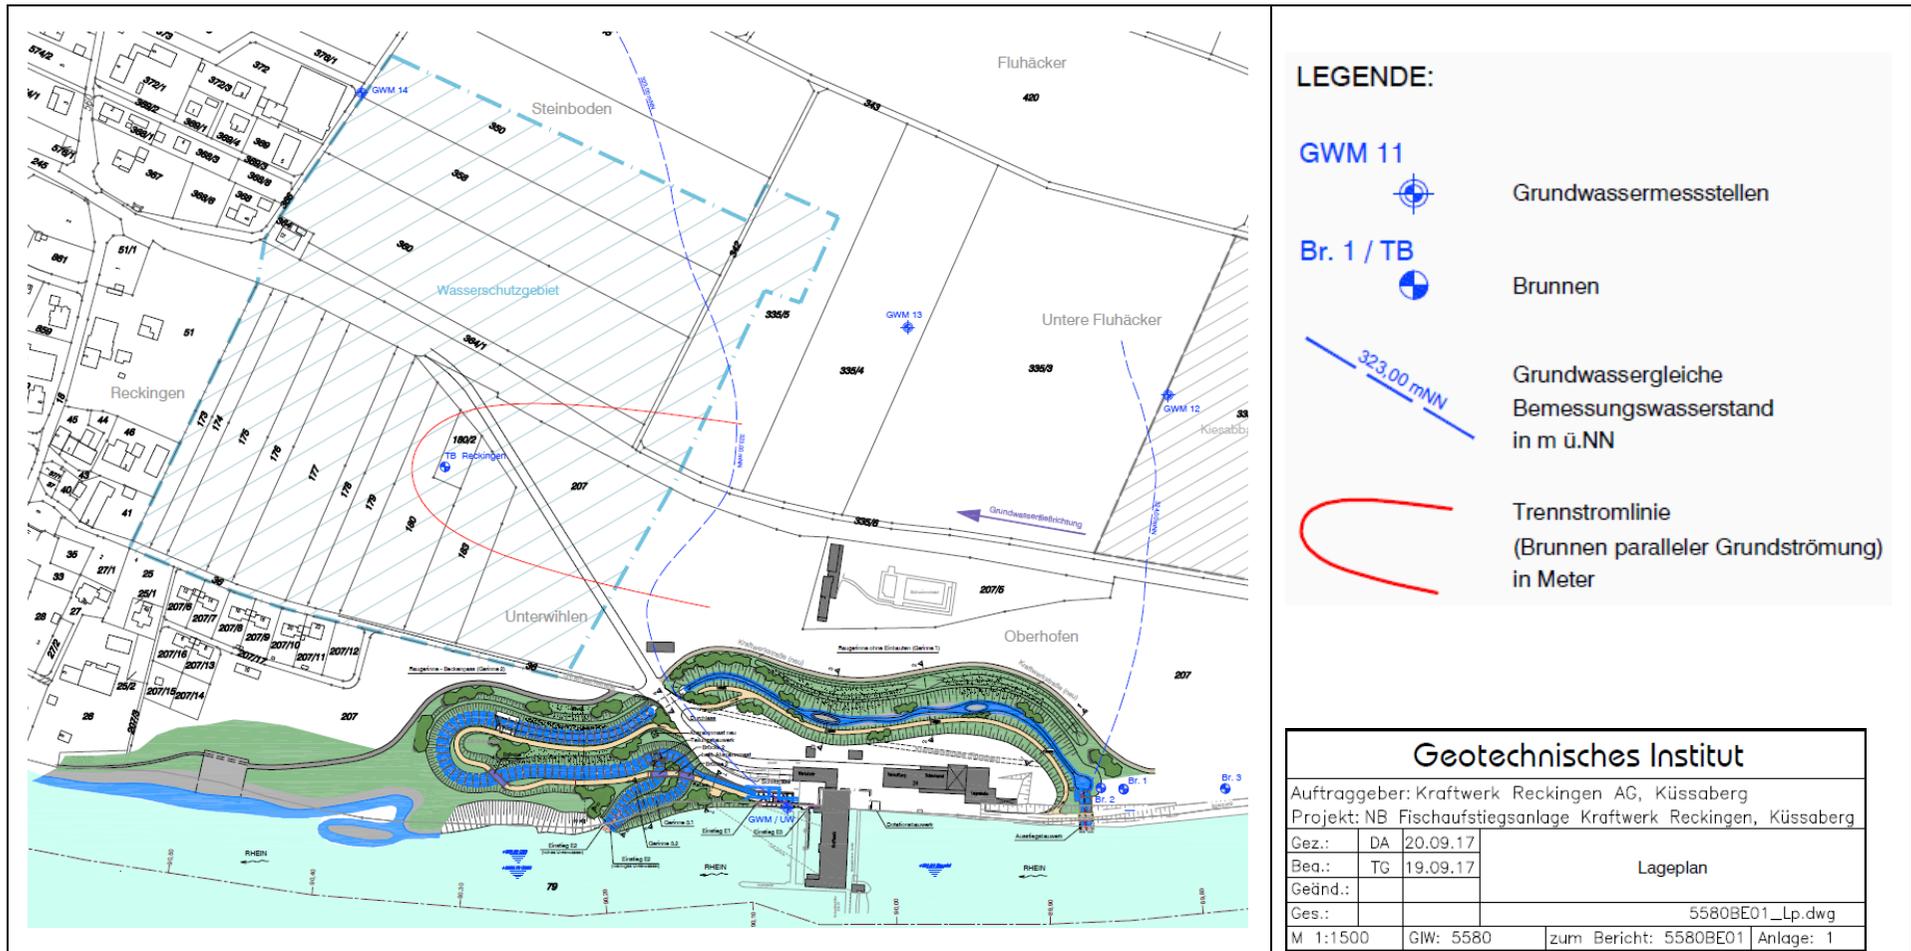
Lageplan der Brunnenanlagen, Grundwassermessstellen und Grundwassergleichen im Nahbereich der geplanten Fischaufstiegsanlage
